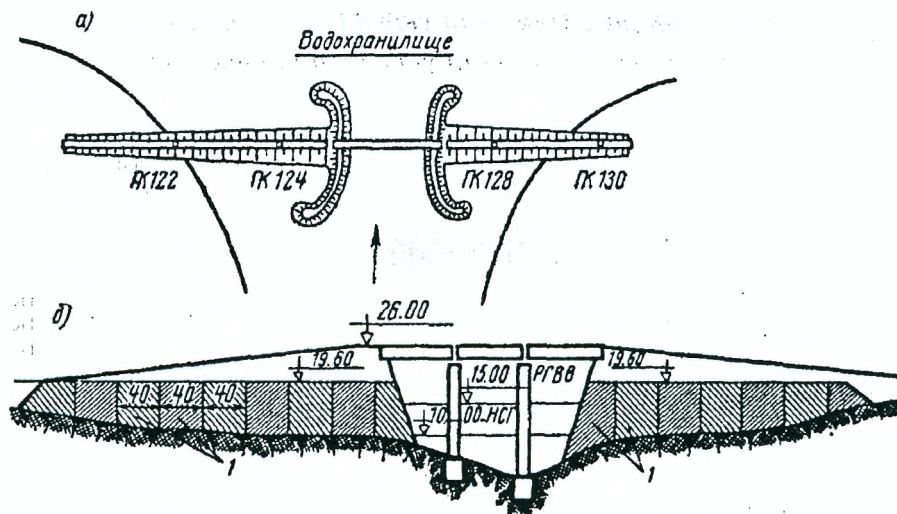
Мостовой переход в зоне водохранилища: а – план; б – продольный профиль; 1 – сборные железобетонные плиты
